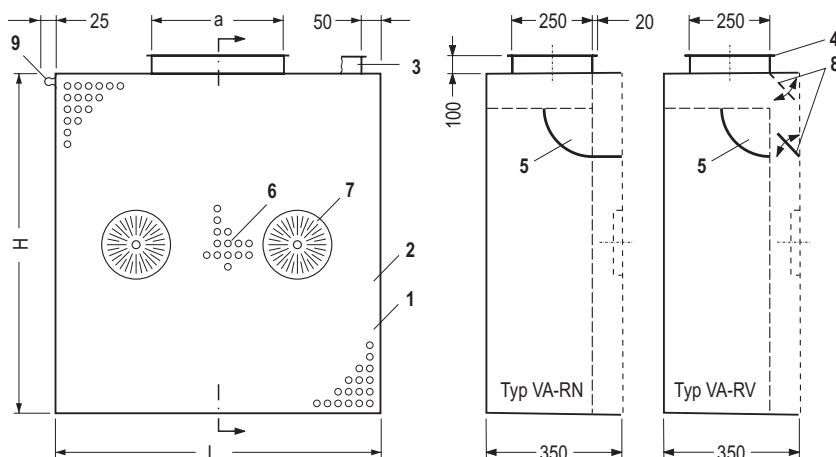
Rechteckiger Verdrängungsauslaß, Normgrößen mit Abmessungen und Gewichten
